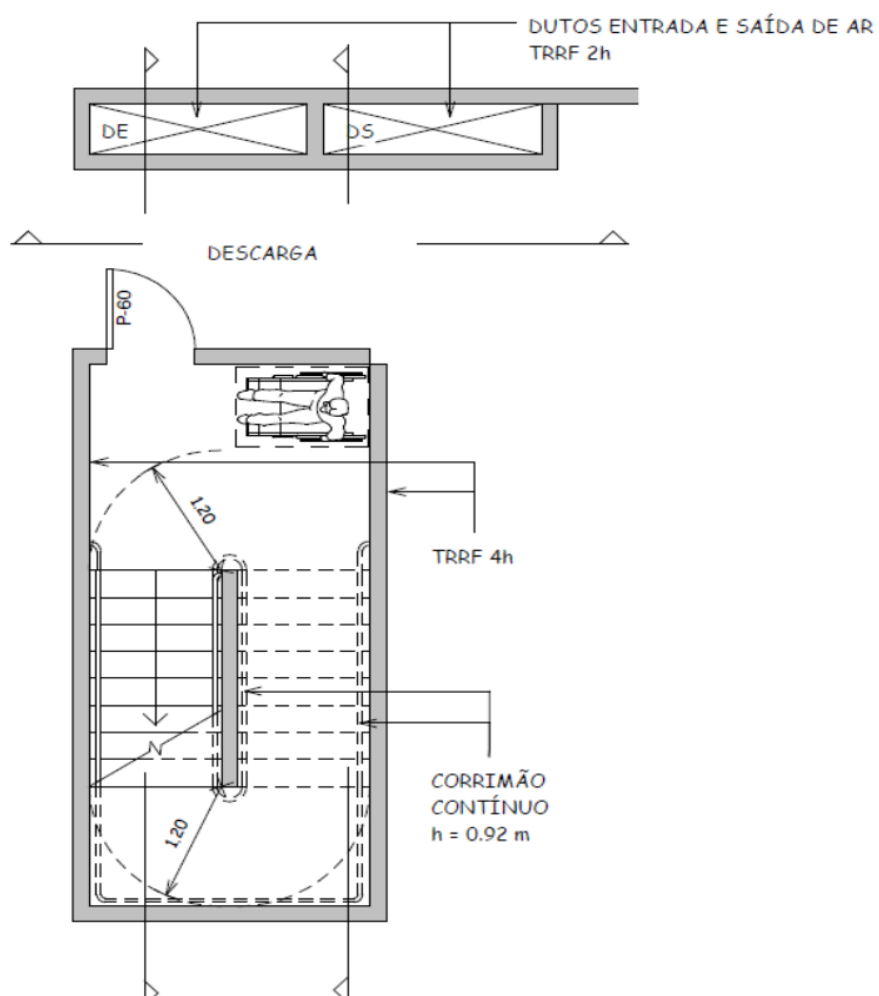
A - Escada à prova de fumaça - térreo (planta baixa).
